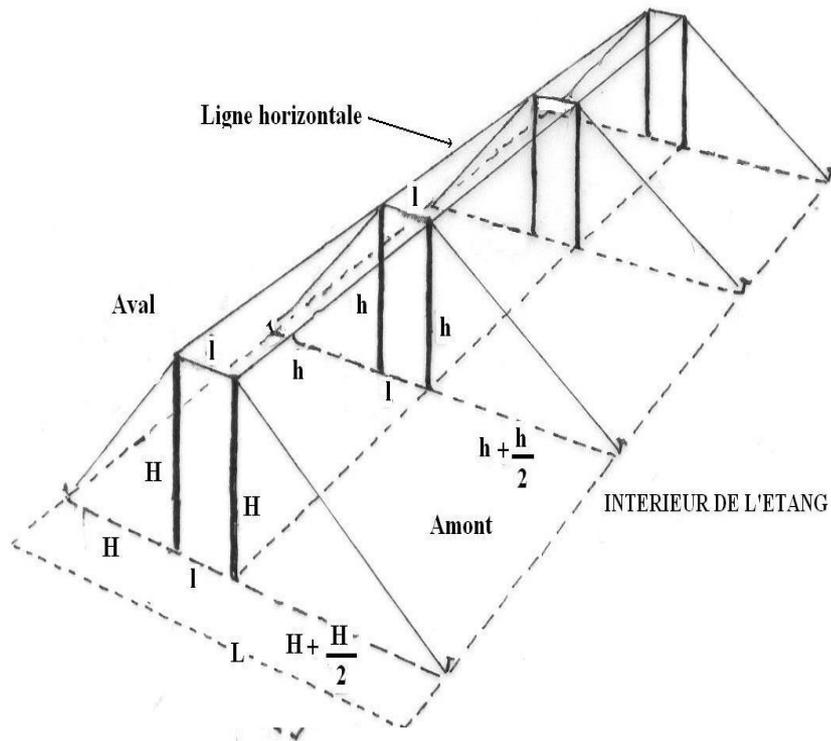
Emplacement des piquets pour l'aménagement de digue
